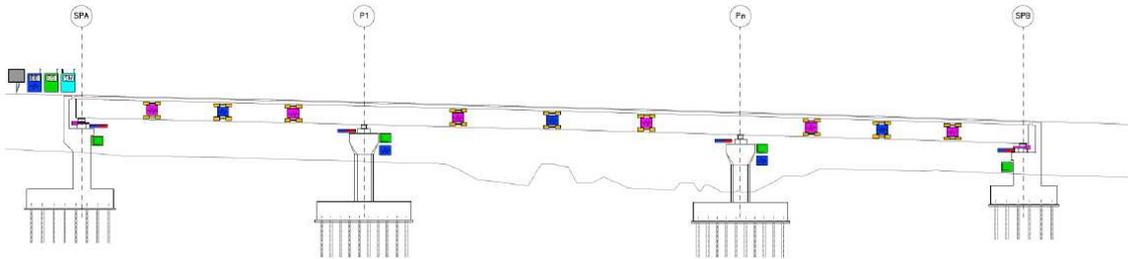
Schema profilo impalcato posizionamento strumentazione viadotti
